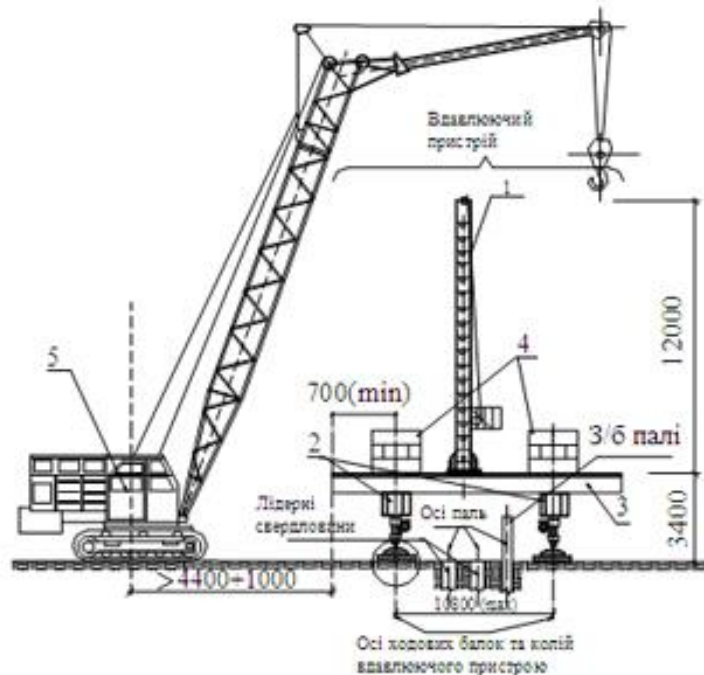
Схема вдавлюючого пристрою: „шахта” (L = 12м) з гідродомкратом, що створює зусилля 2500 кН (1); ходові балки довжиною 10м (2); робочі балки довжиною 12м(3); залізобетонні блоки привантаження (4)
